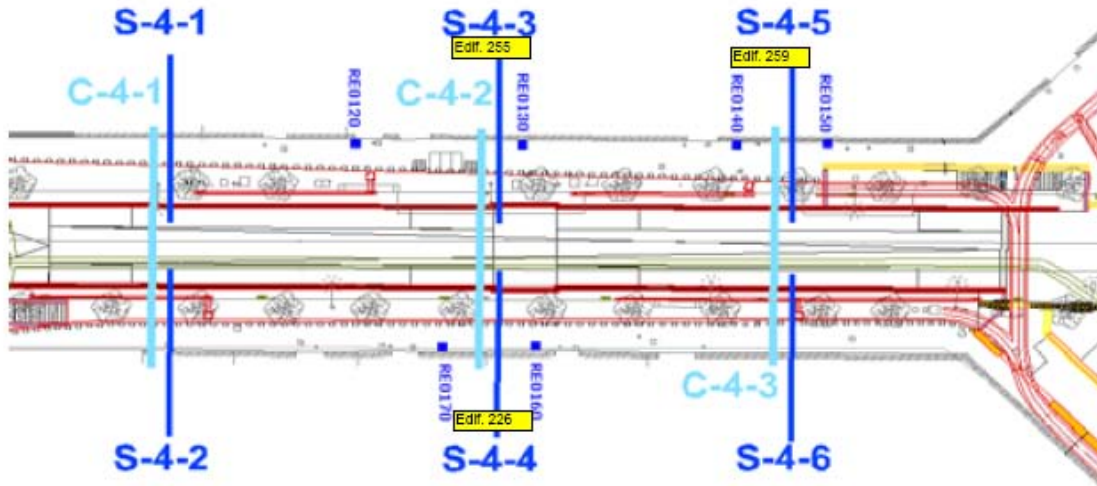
Planta de situación de la instrumentación. Regletas en edificios
